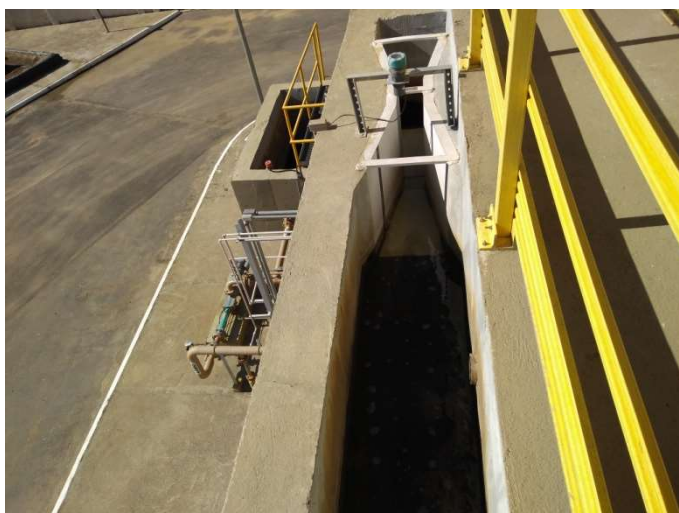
Calha Parshall com Medidor de Vazão Ultrassônico, Saída do Decantador Primário
